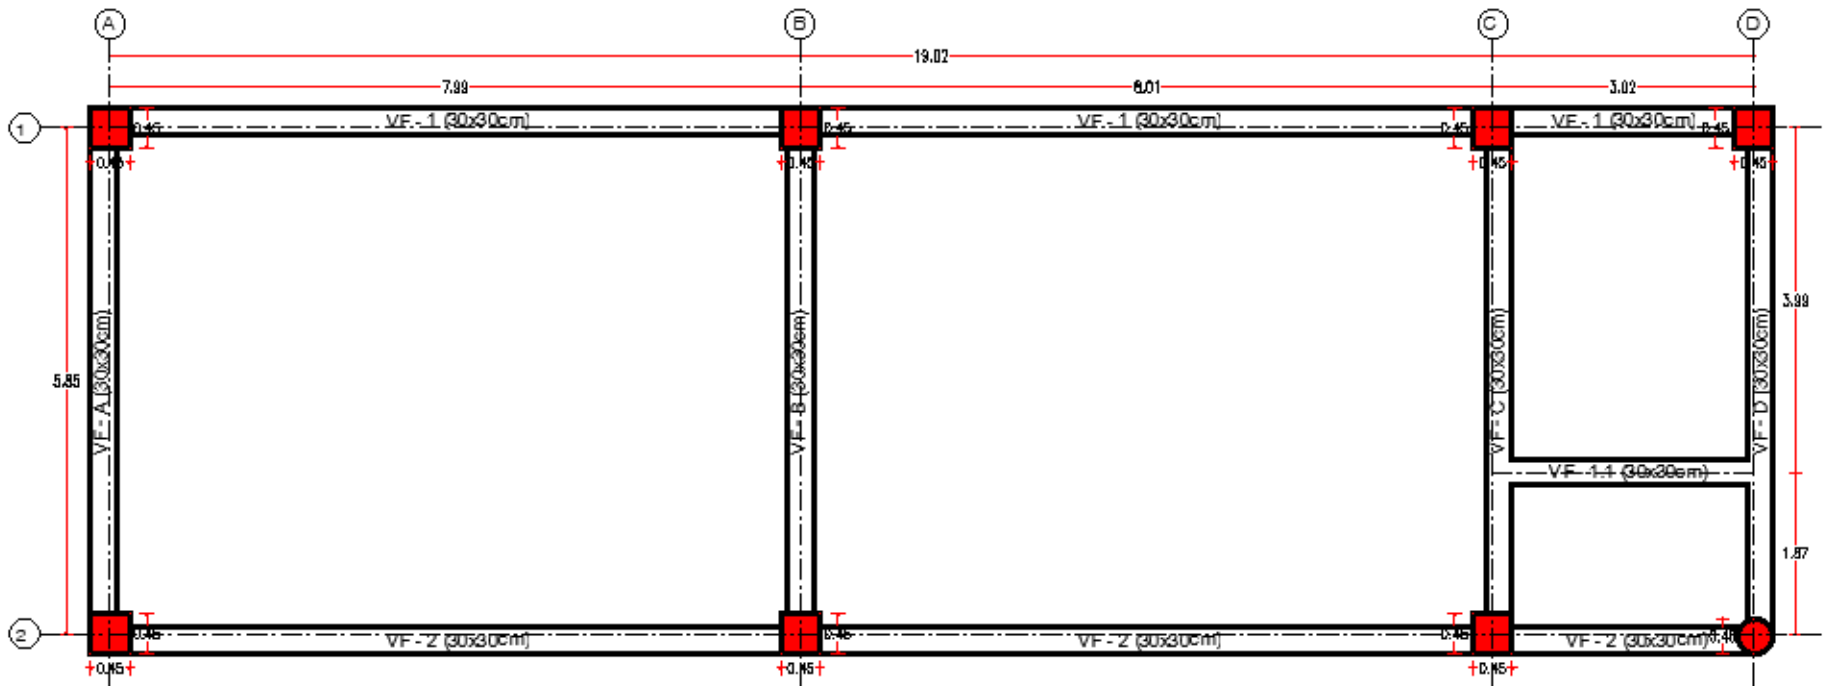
Vista en planta de vigas de fundación (Elaboración propia).
